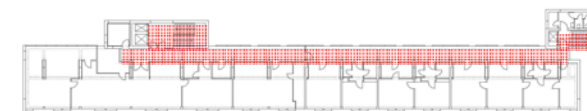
Regelgeschoss - Grundriss 2.OG
